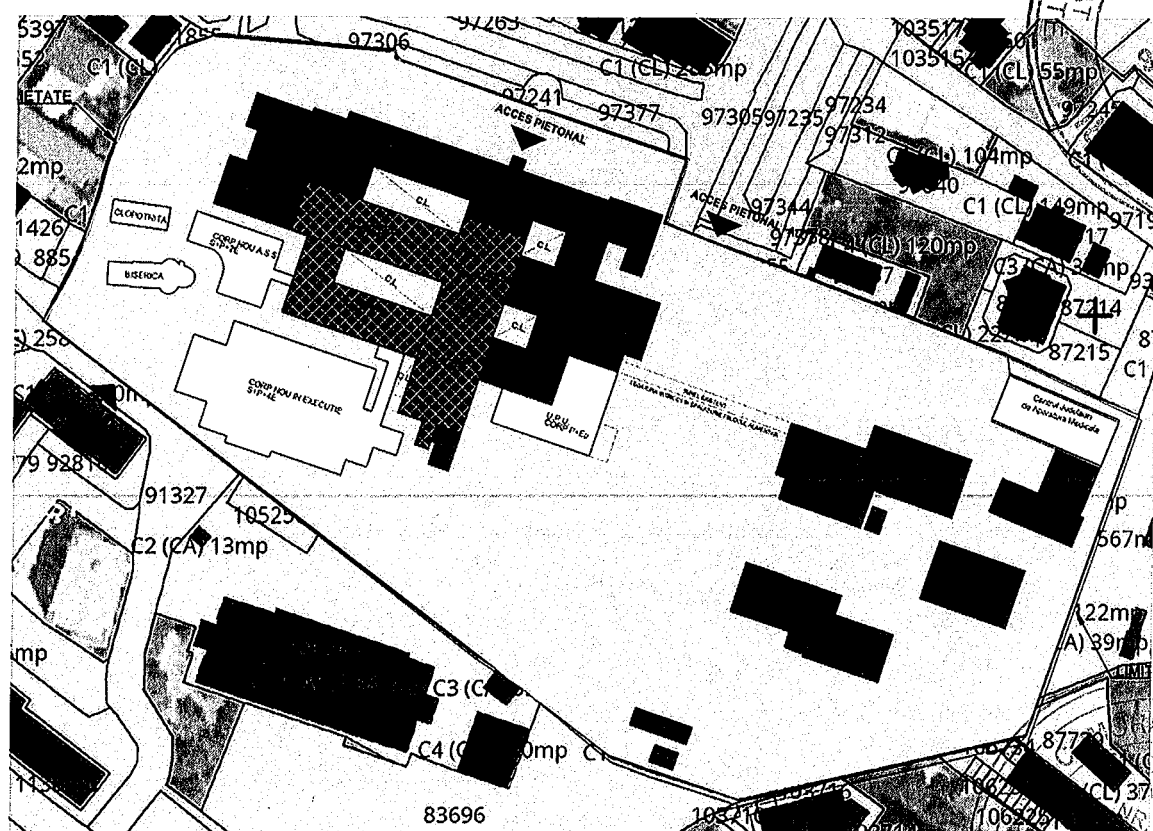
Plan de situatie cu dispunerea corpurilor existente in amplasament.
